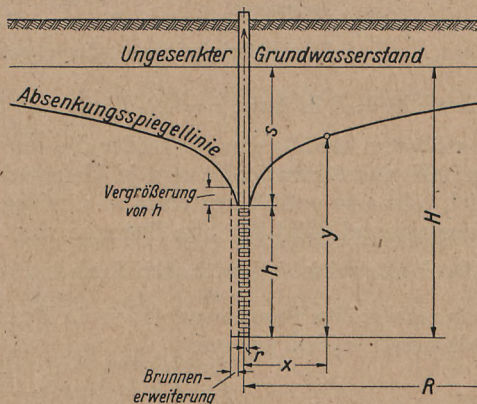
Spiegellinie des abgesenkten Grundwassers (vereinfacht)
